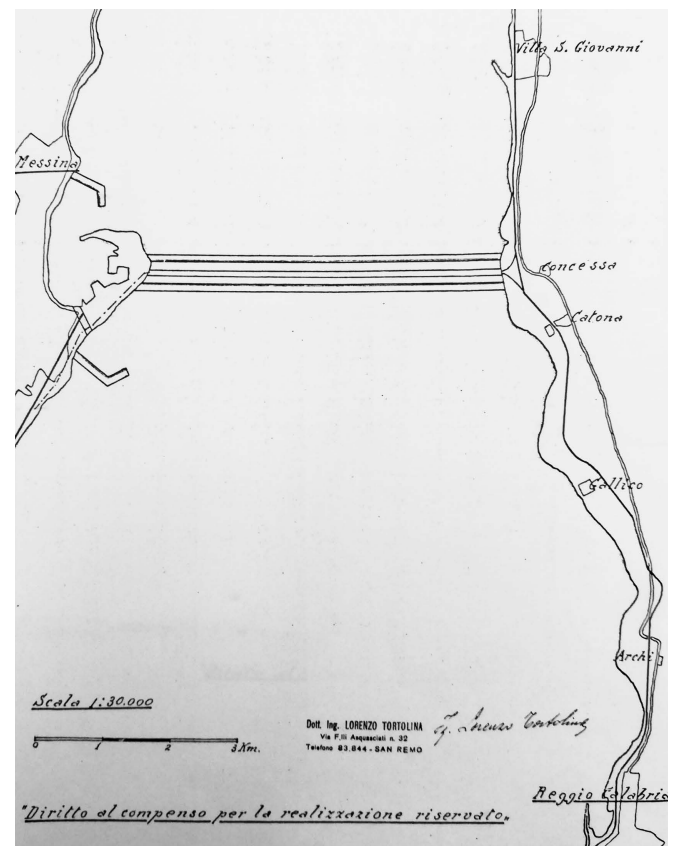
L. Tortolina, progetto di massima per il ponte galleggiante sullo Stretto di Messina. Planimetria generale dell'area dello Stretto, 1971 (Roma, ACS, Istituto Ricostruzione Industriale, 5085, b. R408).
